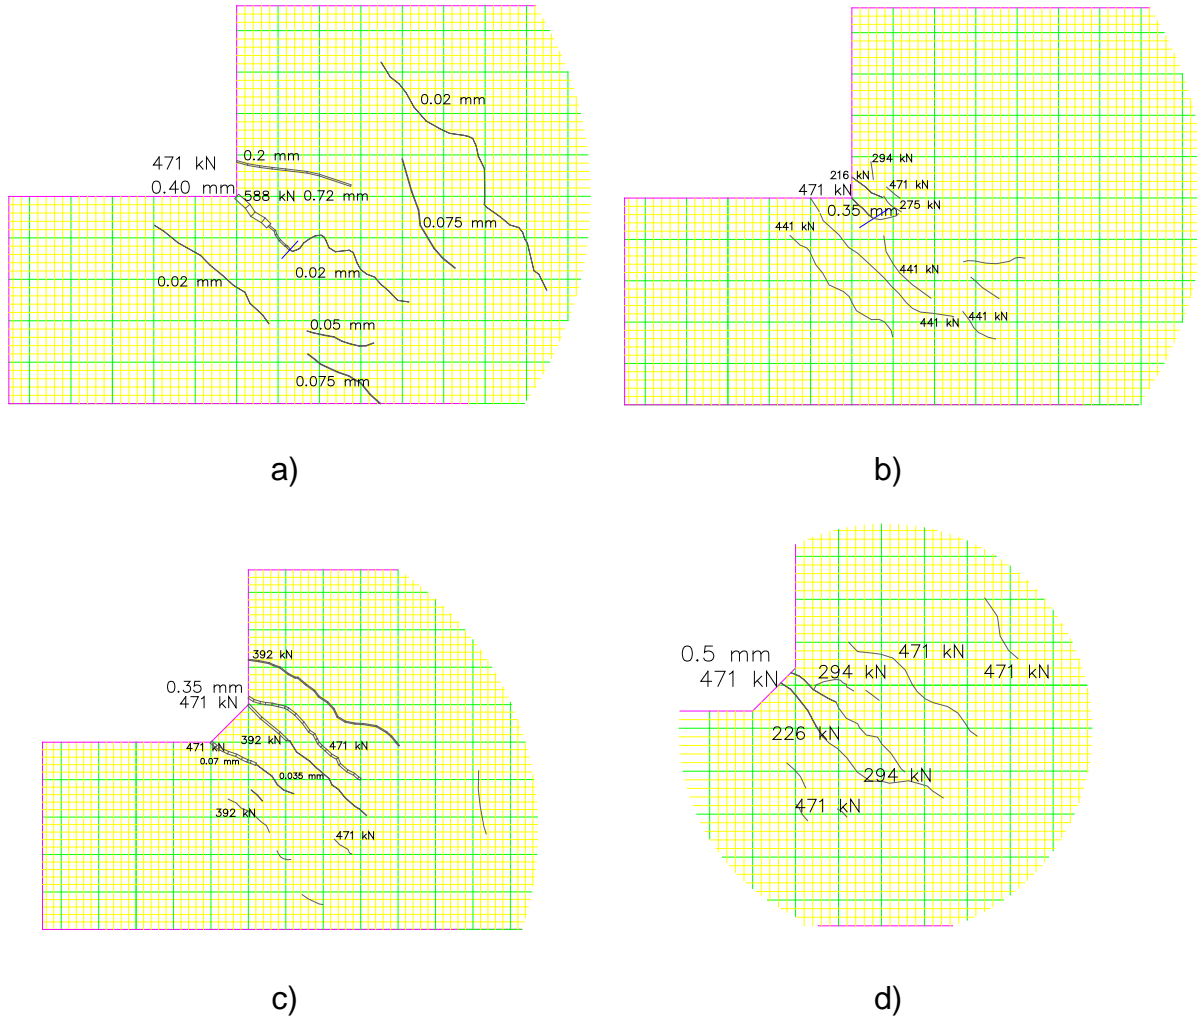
Agrietamiento en la esquina reentrante bajo carga excéntrica última de diseño: a) espécimen E1, b) espécimen E2, c) espécimen E3 y d) espécimen E4
